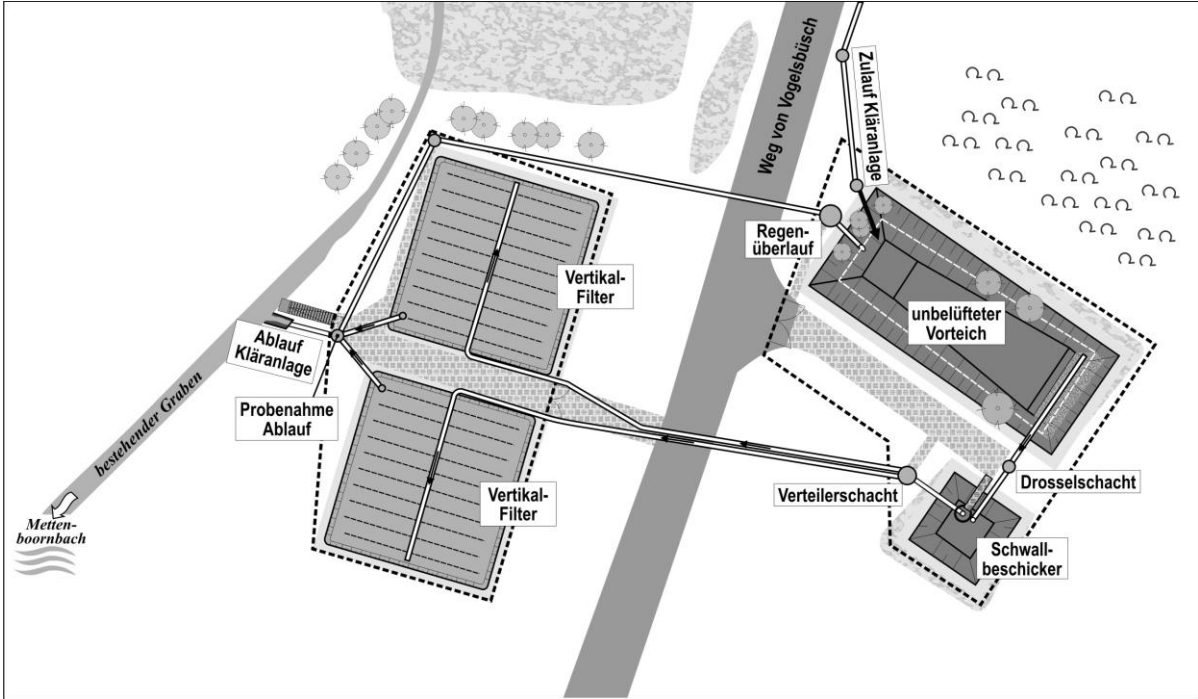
Lageplan zur Kläranlage Vogelsbüsch
